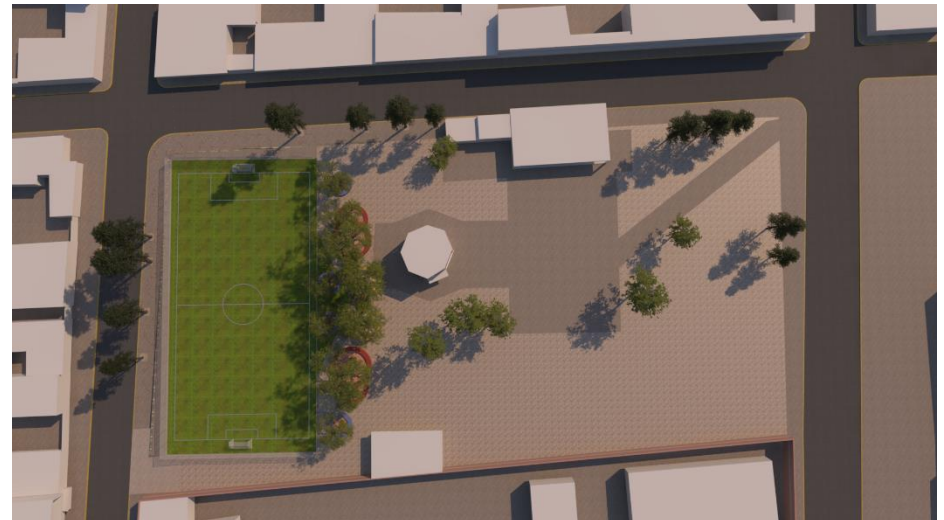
Planta de conjunto de la propuesta final. (Autoría).
